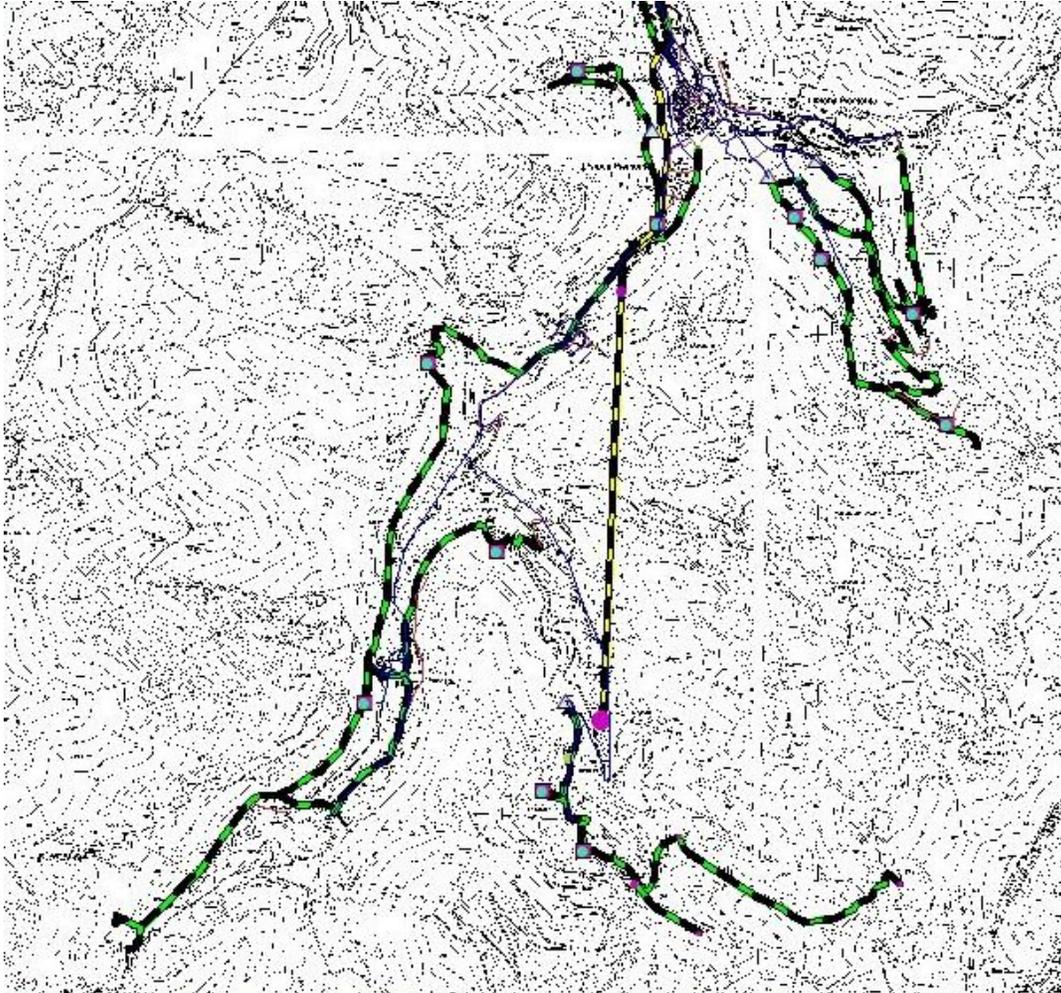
Estratto CTR e planimetria rete idrica Comune di Limone Piemonte
